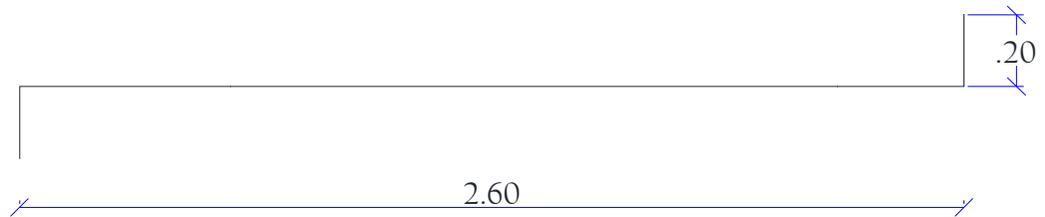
ACERO DE REFUERZO DEL VÁSTAGO DEL MURO
